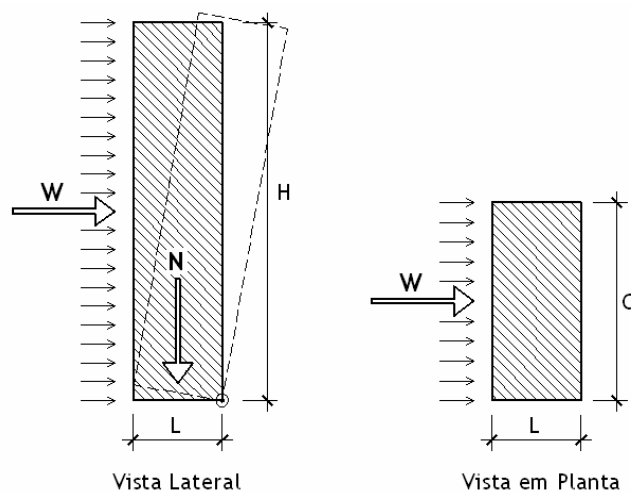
Vista lateral e vista em planta de uma estrutura solicitada ao tombamento.
